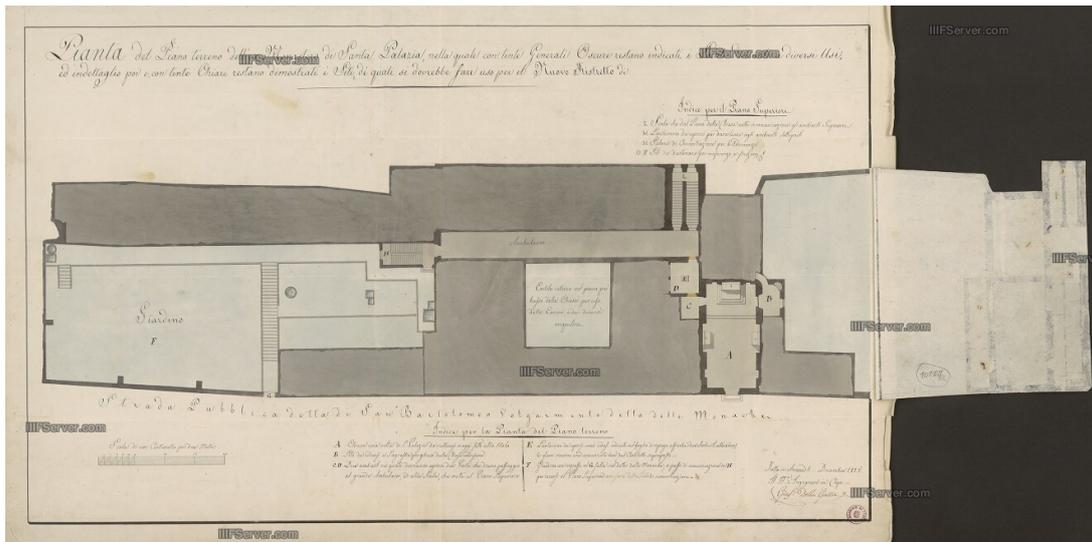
Pianta del piano terreno del Convento di Santa Palazia, Ing. in capo Giuseppe Della Gatta, Ancona Dicembre 1825, Archivio di Stato, Roma
